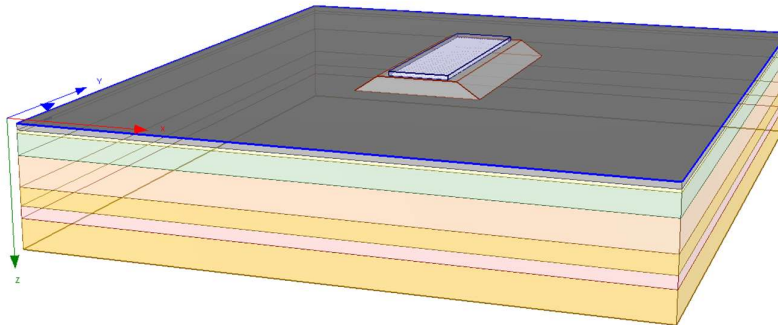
Rilevato sezione n. 496 RI24 alla pk 14+720 - Analisi SLE – Modello di calcolo – Posa Ballast
